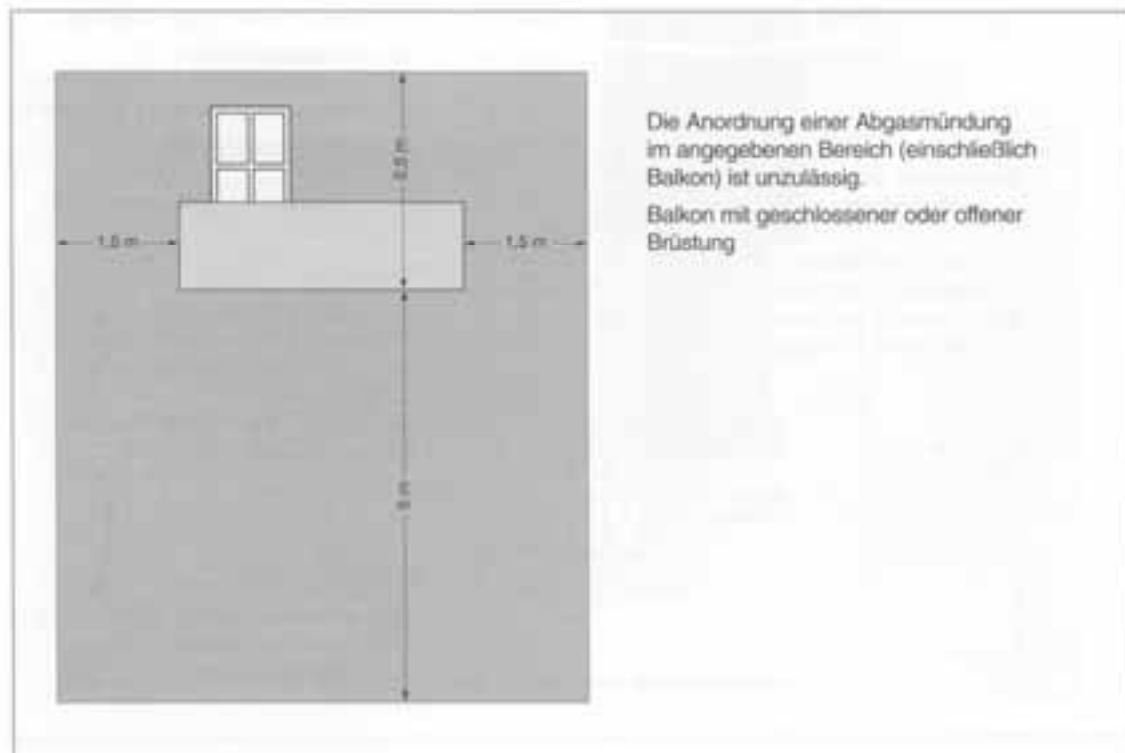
Mindestabstände zur Abgasmündung im Bereich von Balkonen
